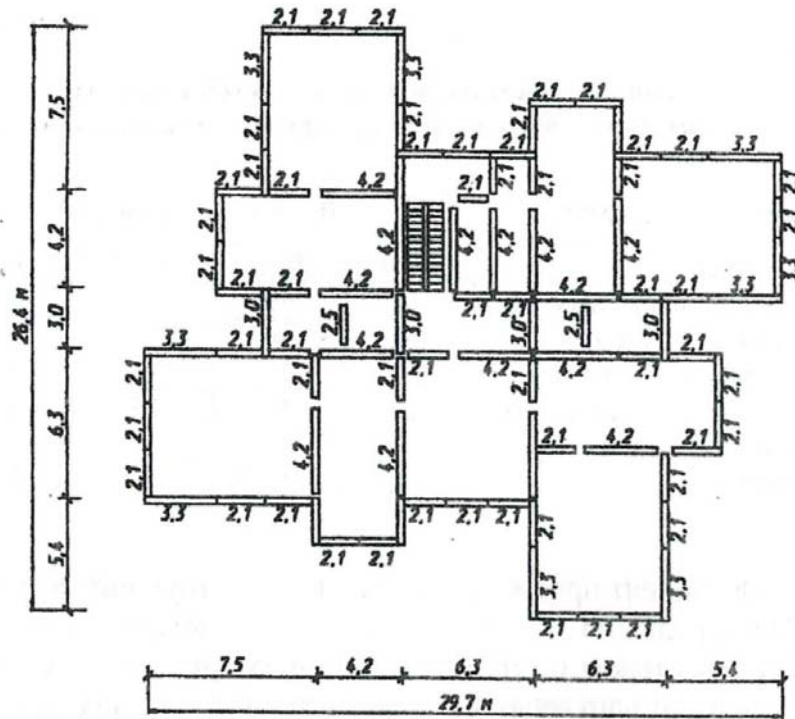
План типового этажа и раскладка стеновых панелей.
